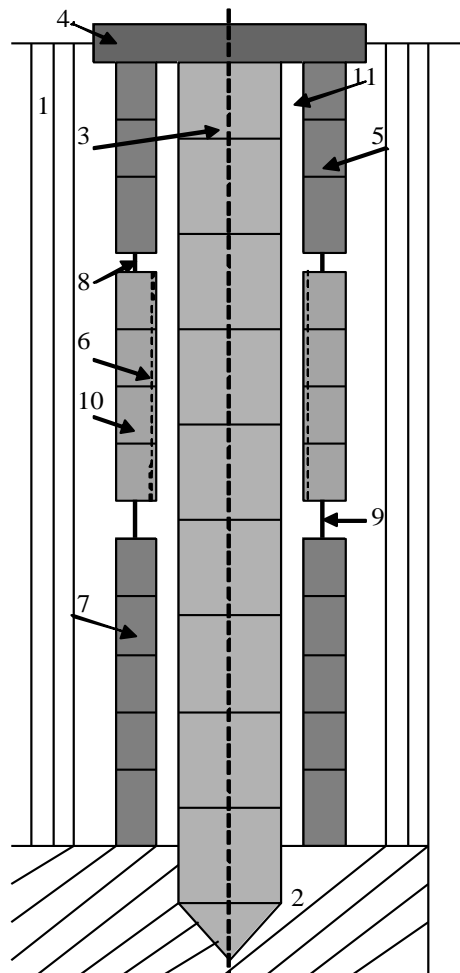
Загальний вигляд пального фундаменту в розрізі: 1 - ґрунт, що самоущільнюється; 2 - ґрунт, що підстиляє; 3 - палія; 4 - ростверк; 5, 6 і 7 - сегменти оболонки; 8, 9 - усічені пірамідальні зуби; 10 - арматурні стрижні для тимчасового кріплення; 11 - порожнина між палею.
